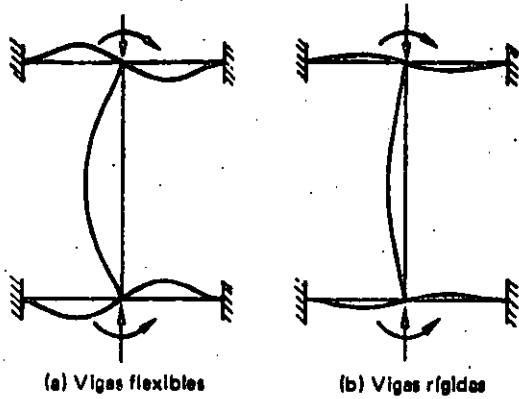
Efecto de la rigidez flexionante de las vigas que restringen a una columna.
